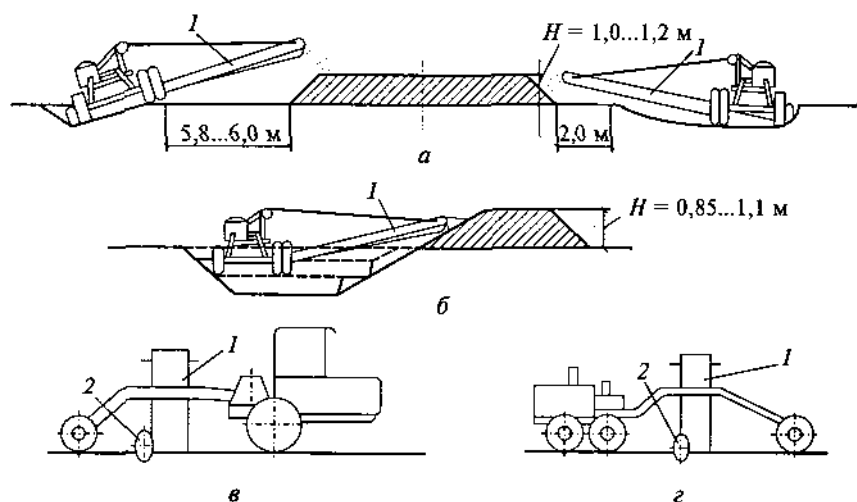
Схемы работы и агрегирования грейдер-элеваторов: а, б — сооружение дорожной насыпи и канала; в, г — полуприцепной и навесной грейдер-элеваторы; 1 — транспортер; 2 — плуг
